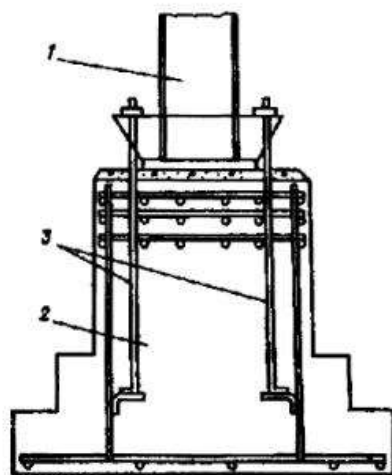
Железобетонный фундамент для стальной колонны:
